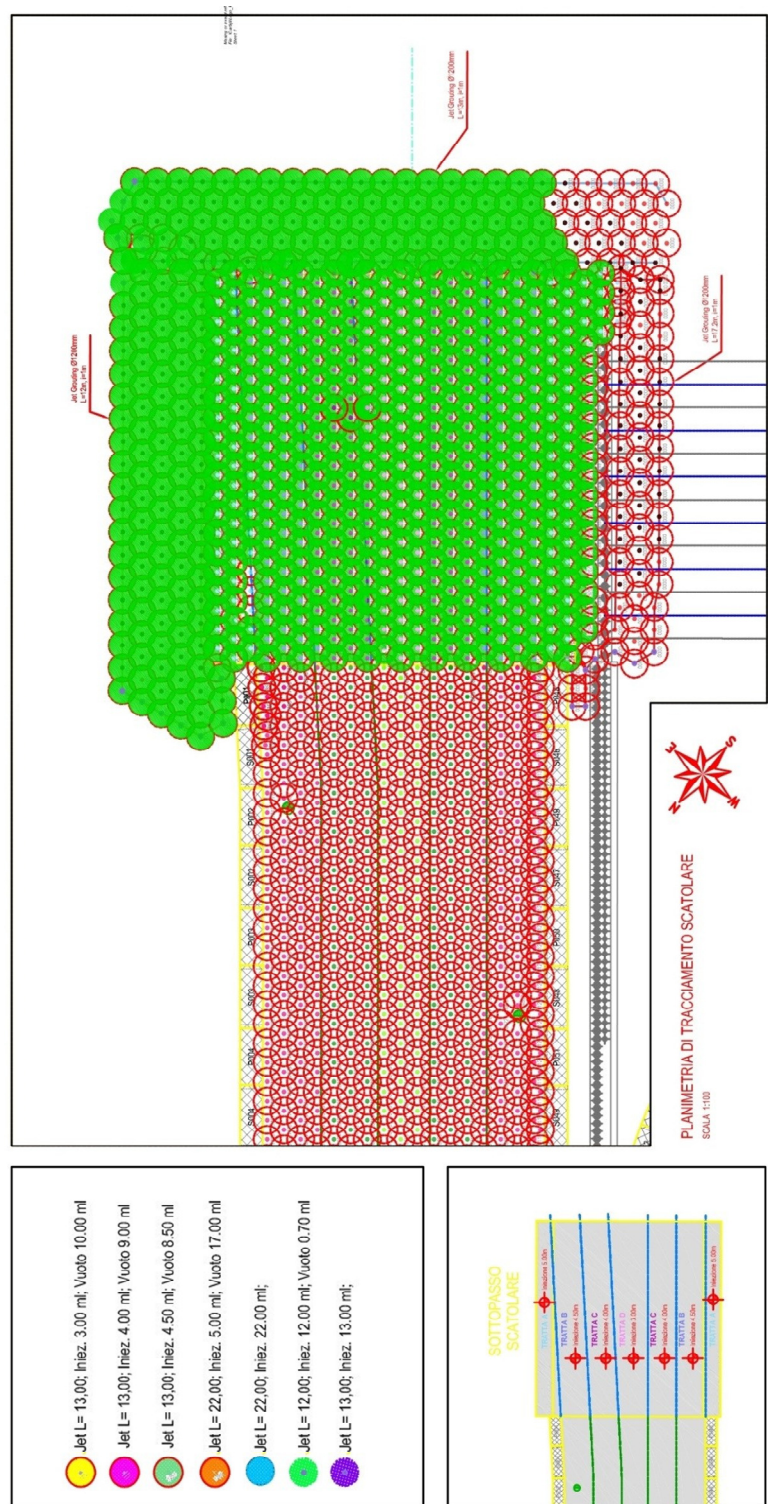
Galleria artificiale Fornaci II – Planimetria 2 di 2 – Tappo di fondo - Trattamento con Jet-grouting realizzato (Da As-Built)
